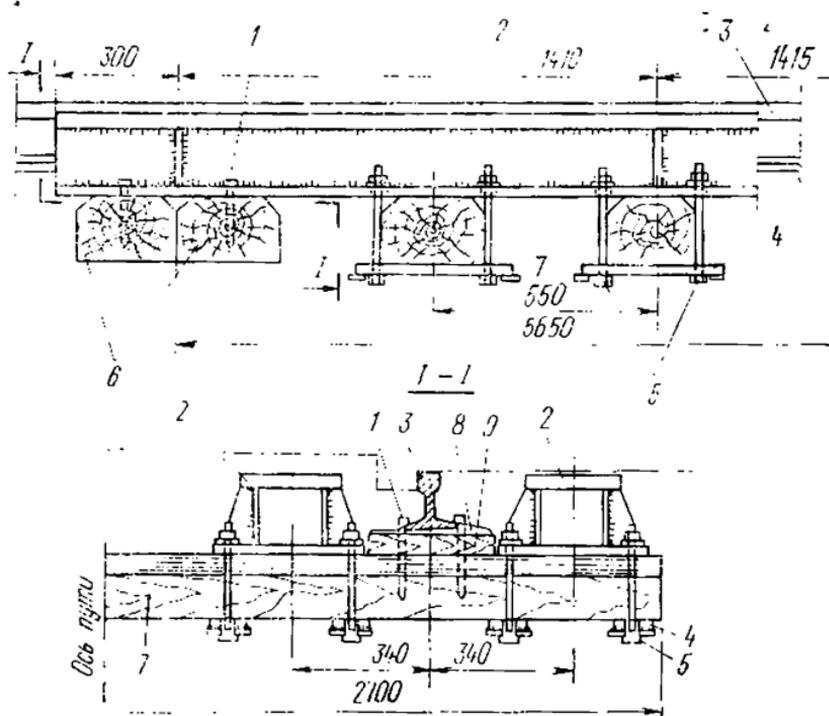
Пакеты сварной конструкции для подвески железнодорожных путей при ограничении скорости движения транспорта до 15—25 км/ч
